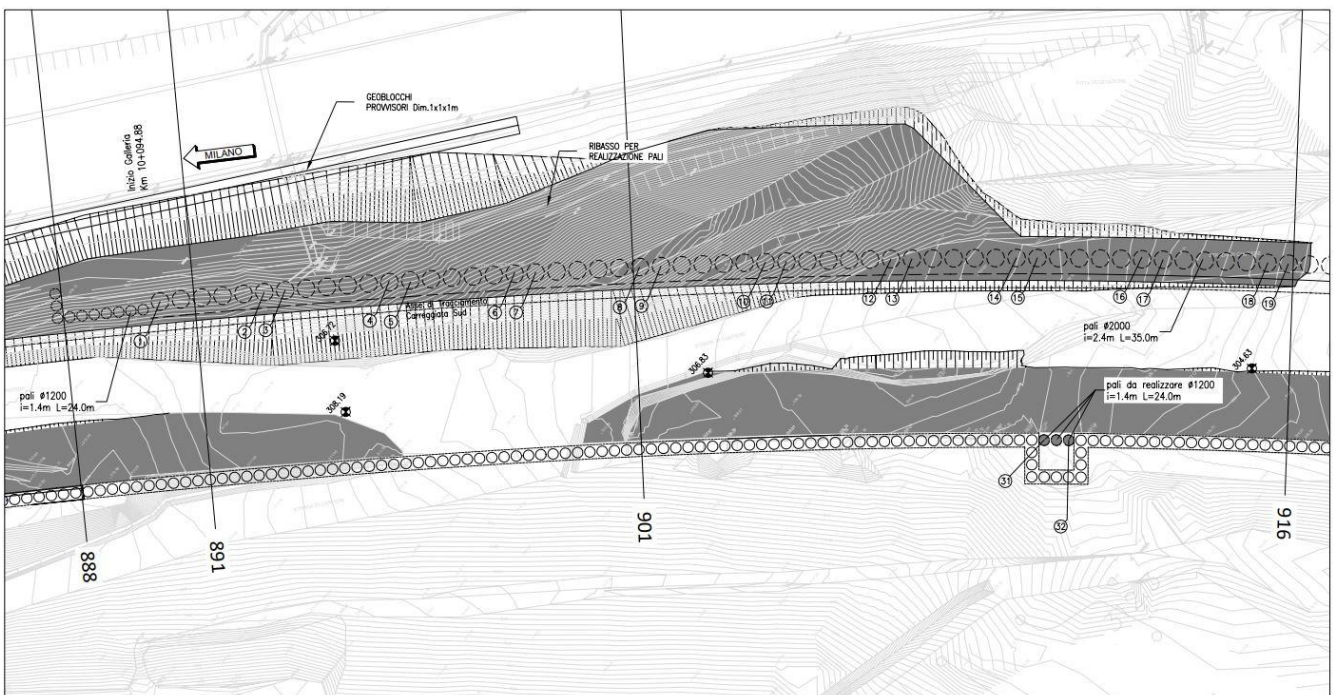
Planimetria area intervento fase 1 (2 di 2)
